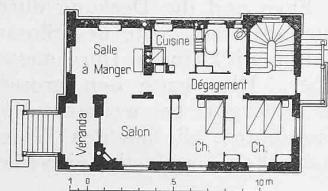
Plan du rez-de-chaussée de la maison Ballissat. — 1 : 400.
